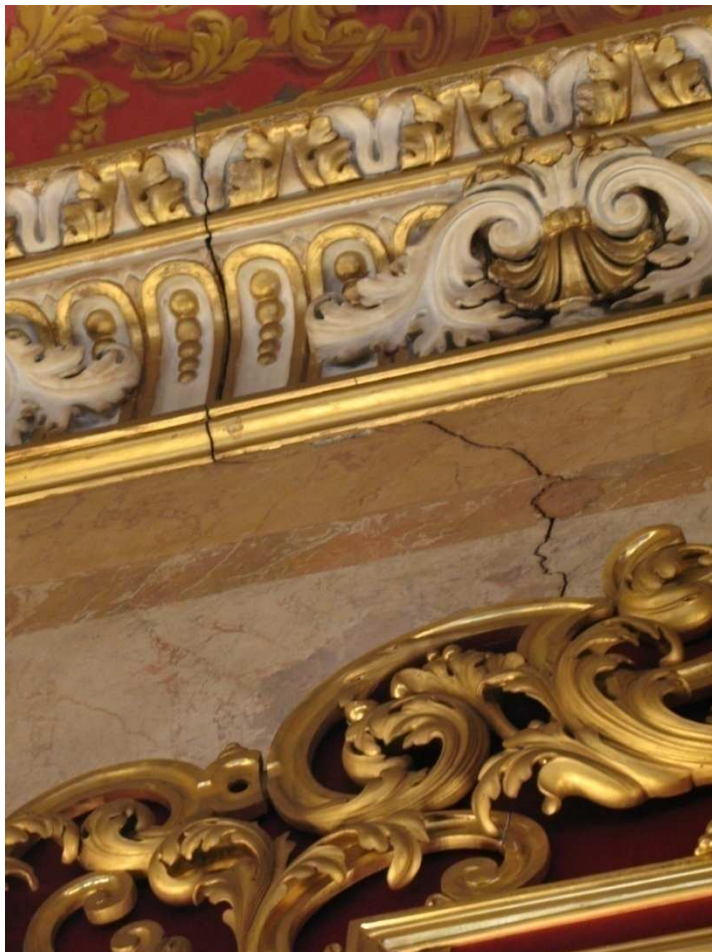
Particolare della cornice della parete opposta alle finestre della piazza; la lesione attraversa la cornice e si propaga nel muro..
